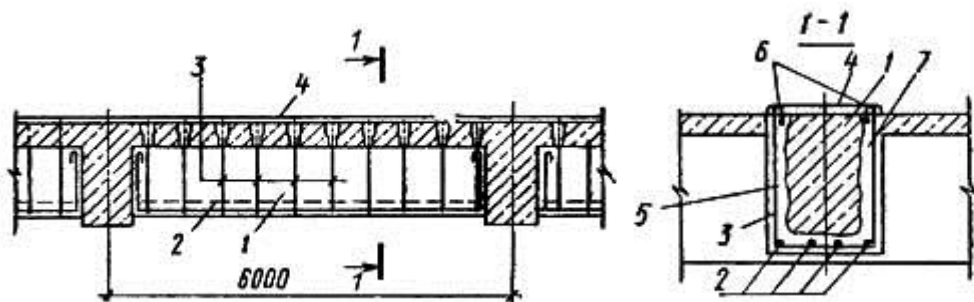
Усиление балки «рубашкой»: 1 – усиливаемая балка; 2 – рабочая арматура; 3 – хомуты; 4 – стяжка; 5 – насечка; 6 – монтажная арматура «рубашки»; 7 – «рубашка»
